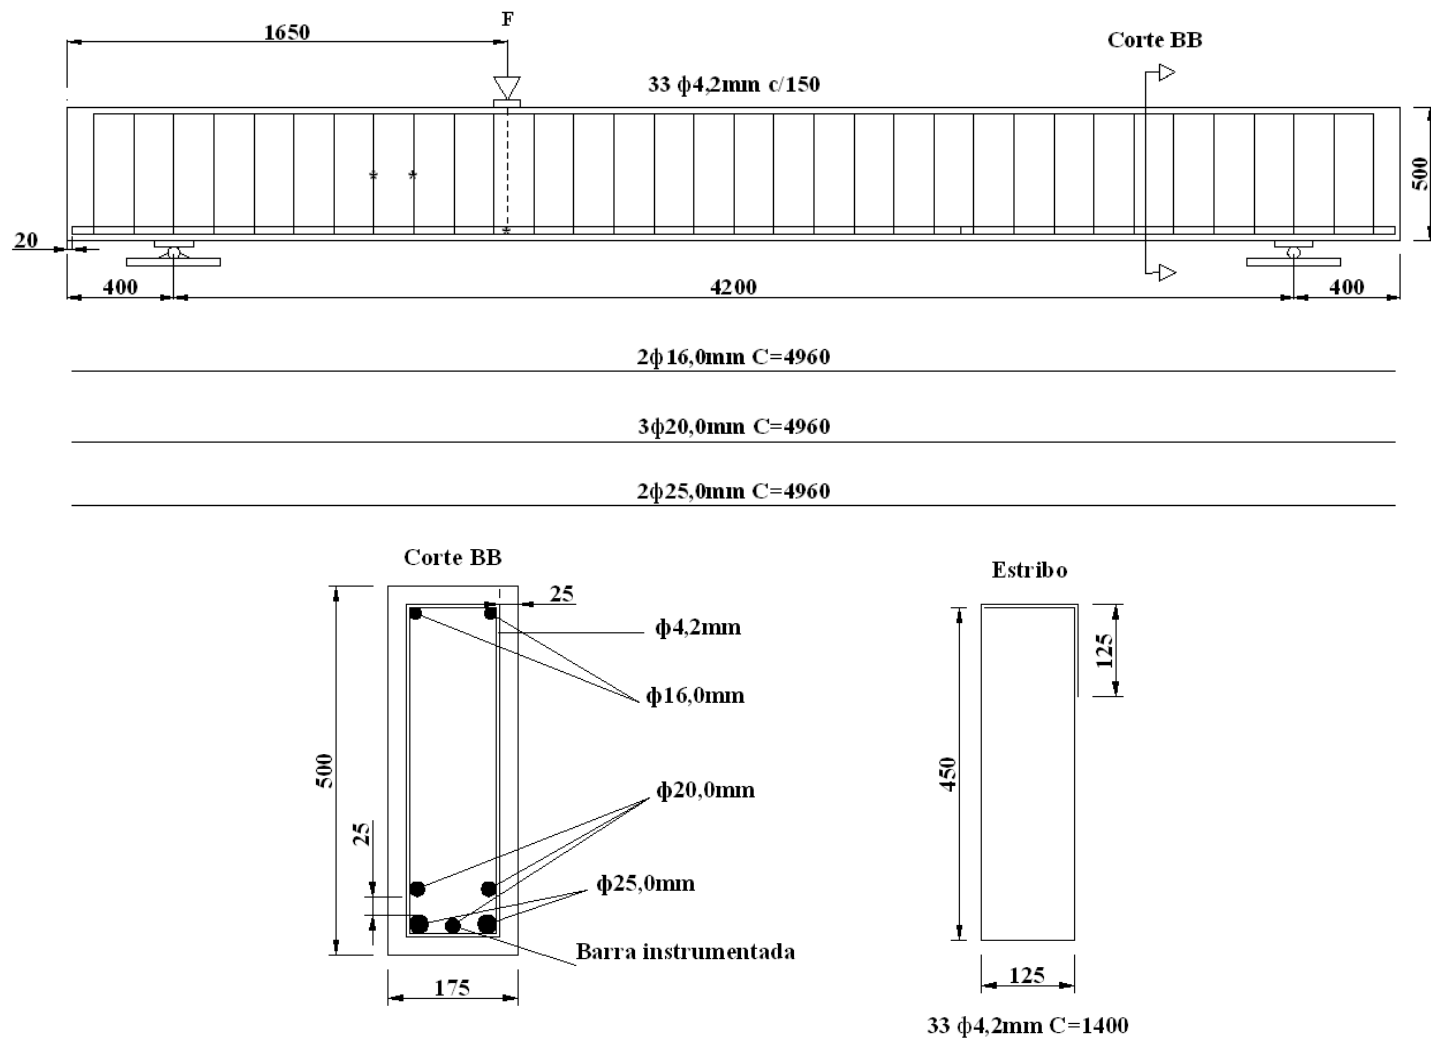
Armaduras e posicionamento dos extensômetros (\*) da viga V2 (dimensões em mm).
